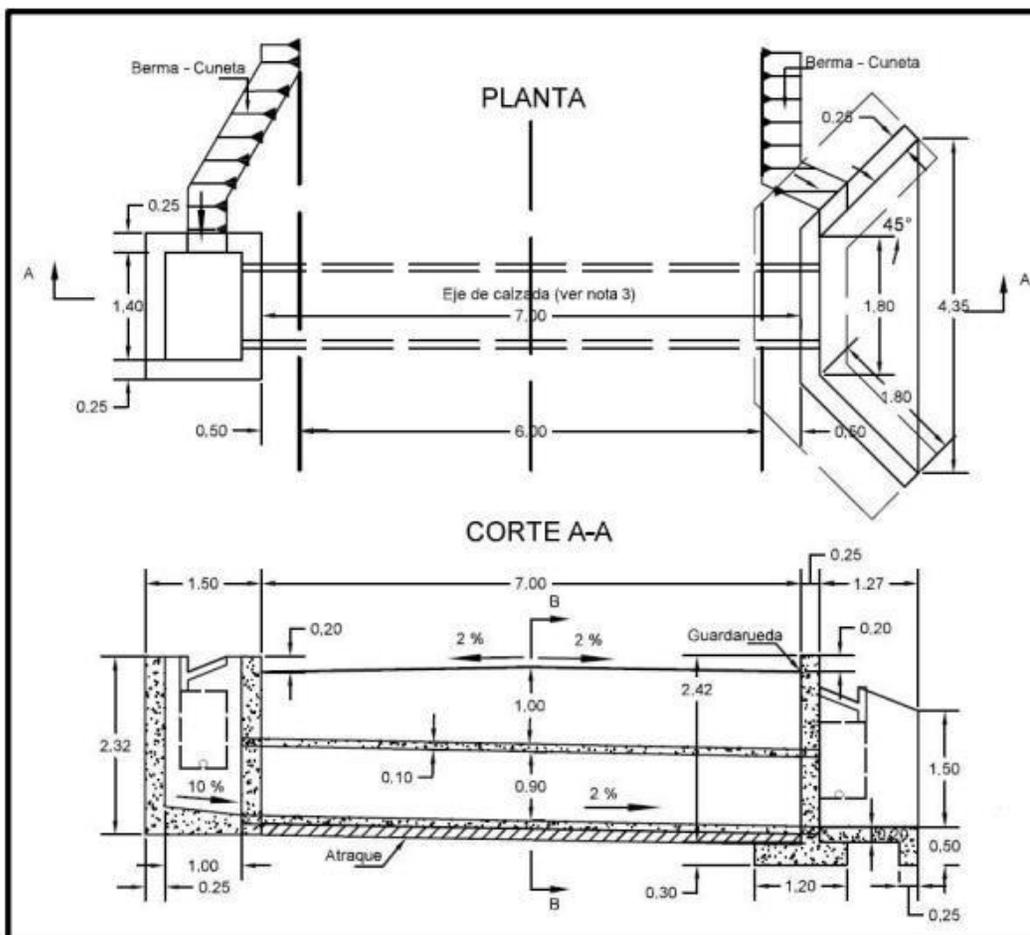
Alternativas para localización en planta de alcantarillas
